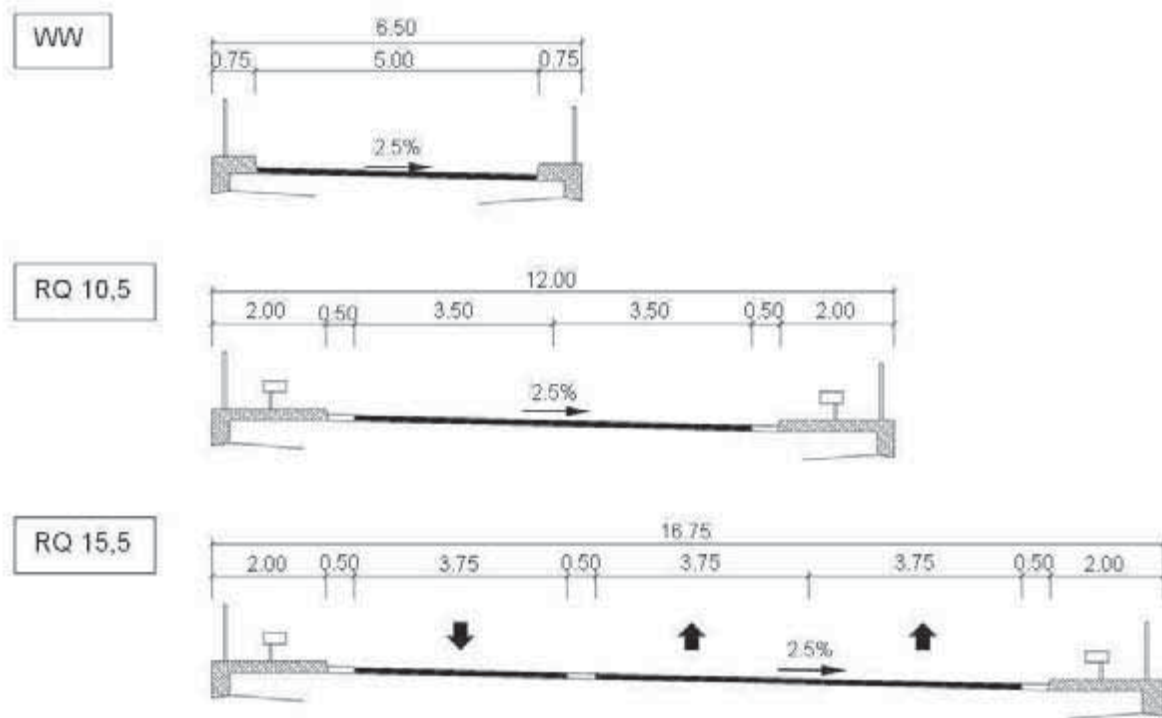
Configurations typiques de ponts mixtes avec éléments de dalle préfabriqués
